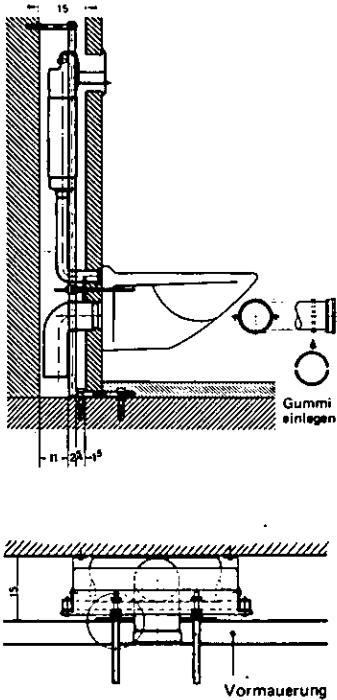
Vorwandinstallation mit Montagefix-Befestigungselementen und Vormauerung für ein Wandklosett mit Wandeinbauspülkasten
